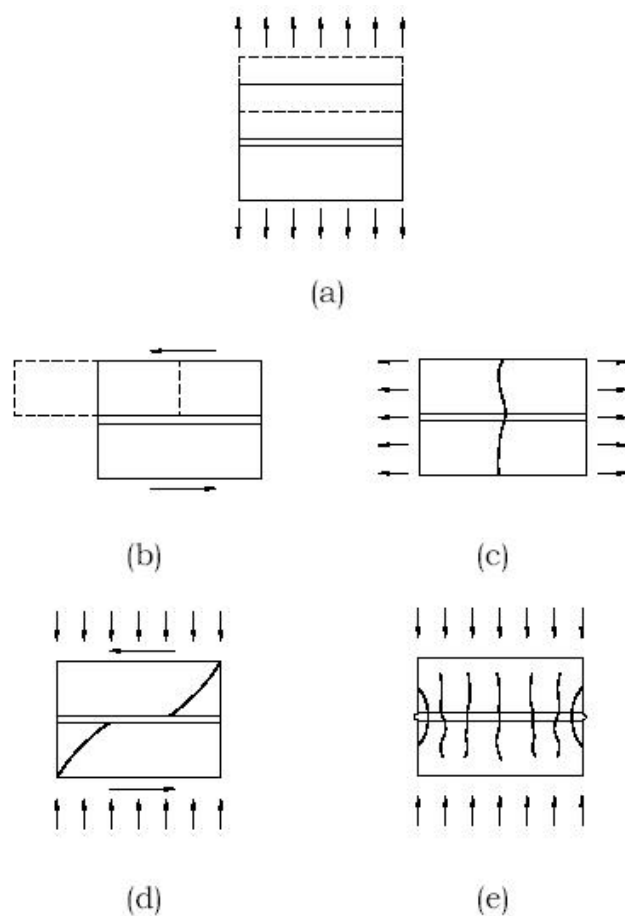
Mecanismos de ruptura: (a) Fissuras nas juntas; (b) Escorregamento; (c) Fissuração das unidades; (d) Fissura diagonal; (e) Fendilhamento (fonte: PELETEIRO (2002))
